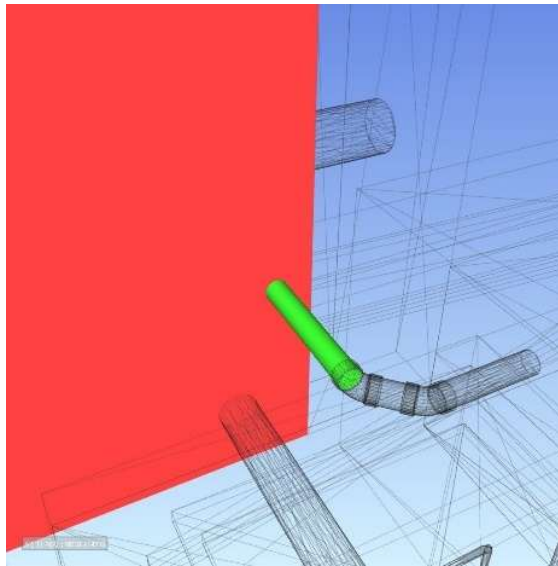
Colisión de drenaje con elemento estructural por mala planificación.
